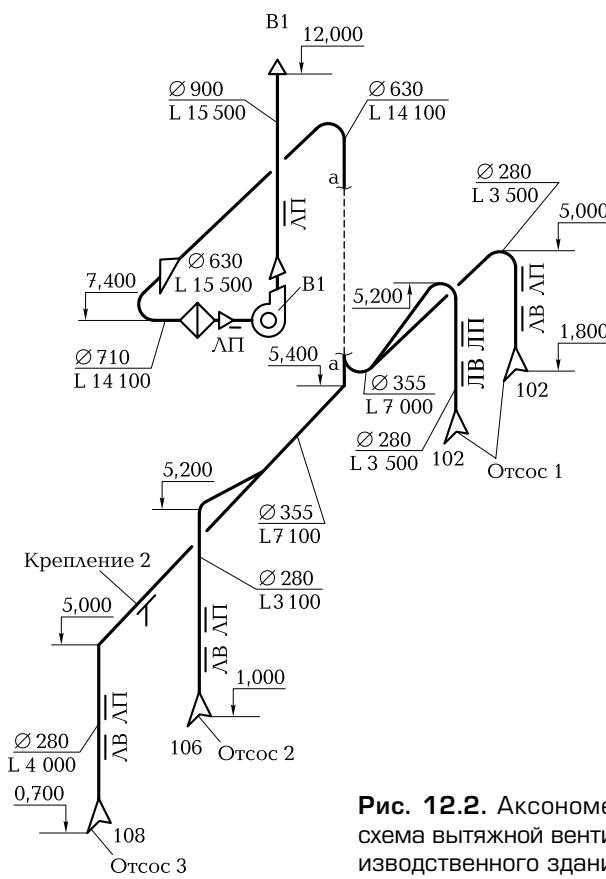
Аксонометрическая схема вытяжной вентиляции производственного здания
